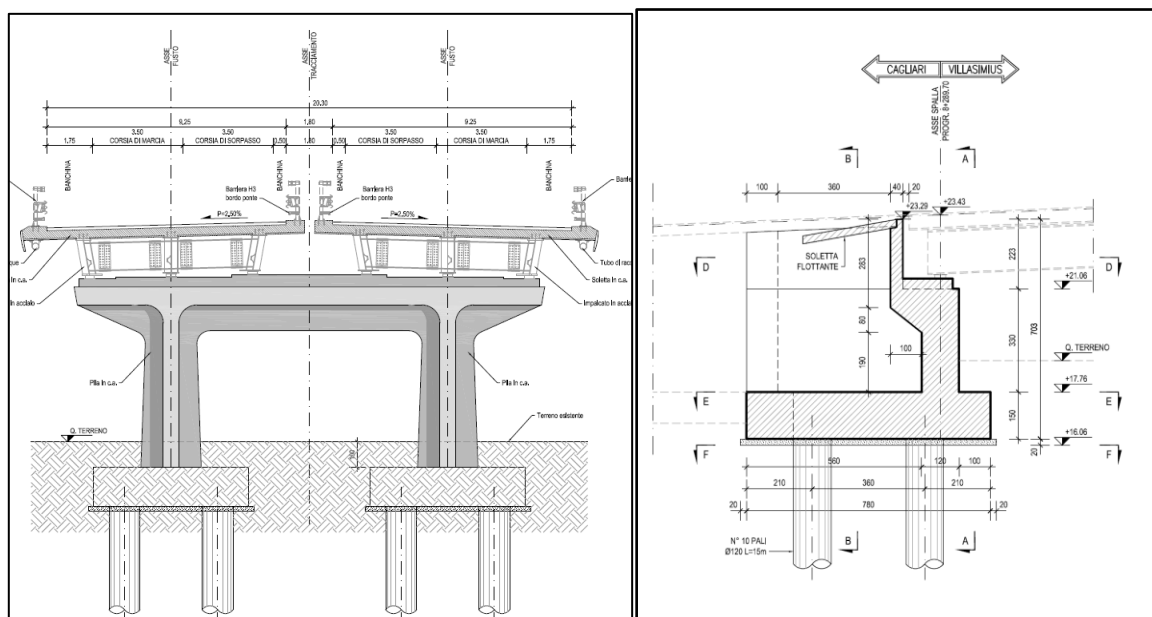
Vista frontale della pila tipo e sezione longitudinale della spalla SP1
